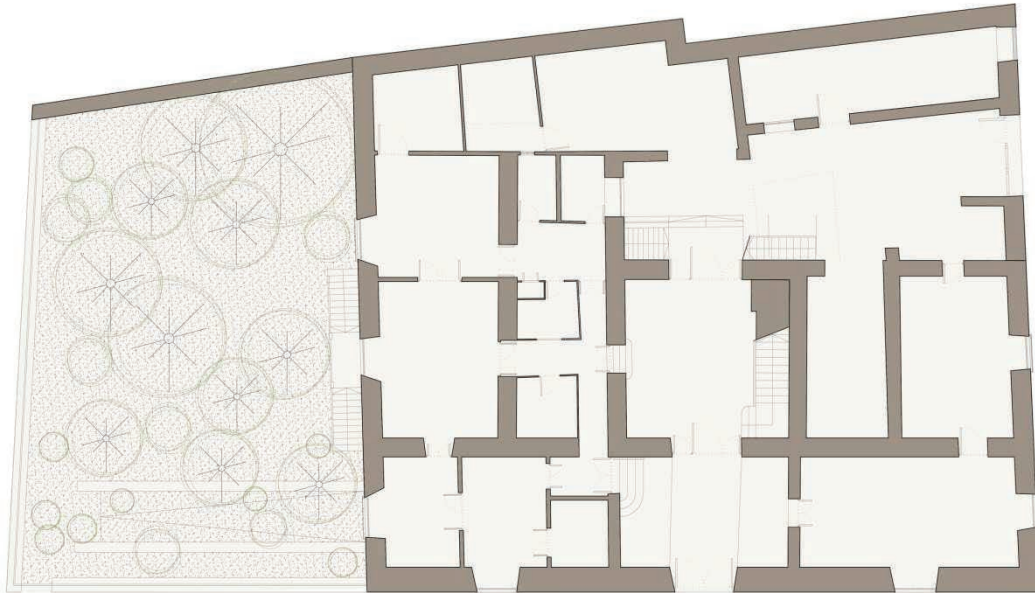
Planta baja de la Casa de los Arcas, por Rosario Baños Oliver
